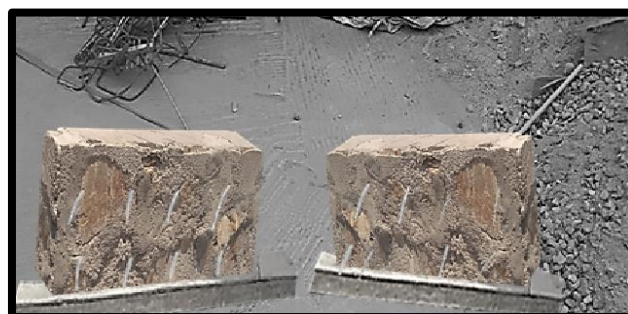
Muretes M1 Y M2 de pirca sin reforzamiento
